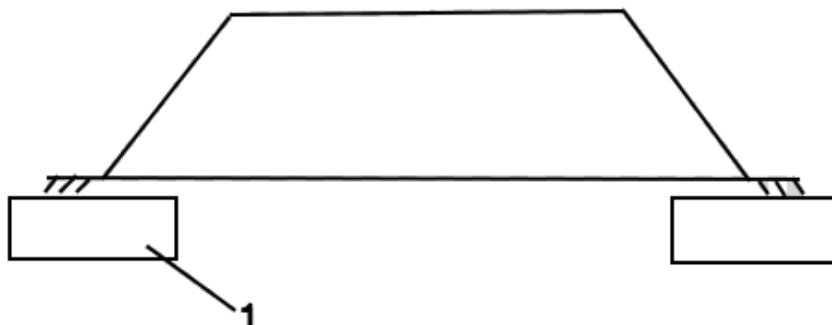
Фундамент для насыпи в виде опор (1), конструкция которых представляет собой грунт, армированный сетками либо решётками
